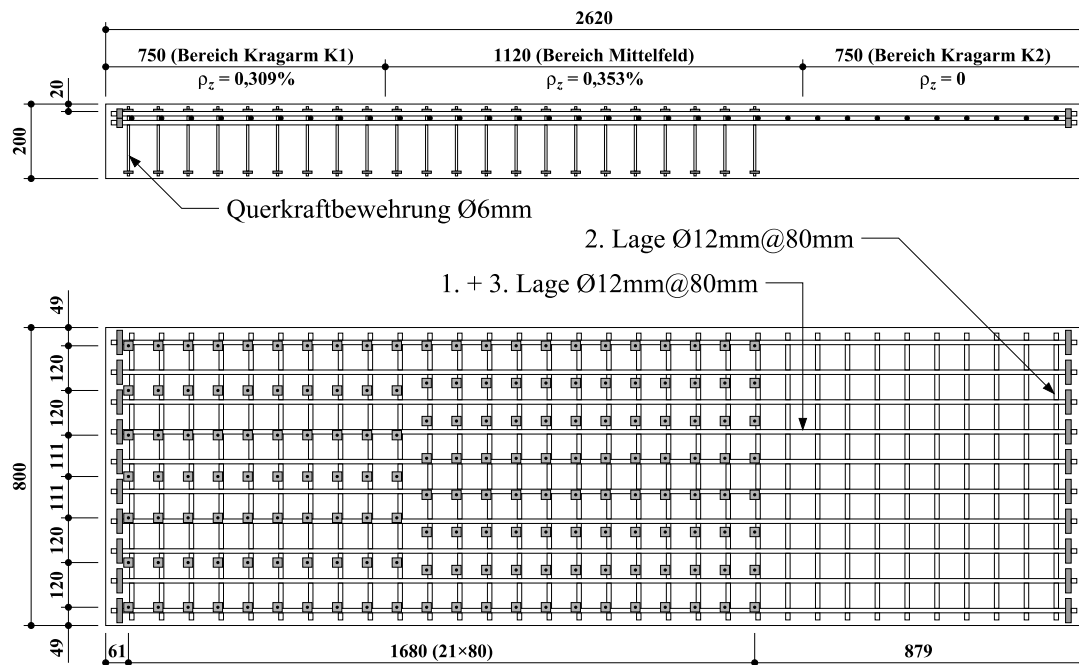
Bewehrungslayout des Versuchs A3V2, Zeichnung entnommen aus [2]
